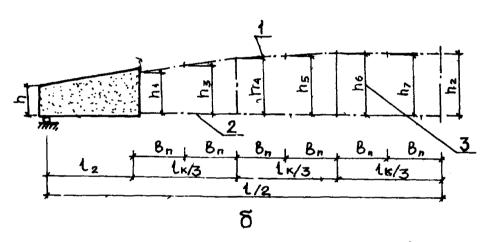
К расчету фермы-диафрагмы по деформациям а 5-геометрические схемы для различных типов панелей-фолочек КСО 3×24 м; 1 -линия, соединяющая центры тяжести сечений верхнего пояса; 2 и 3-то же, сечений нижнего пояса и стоек
